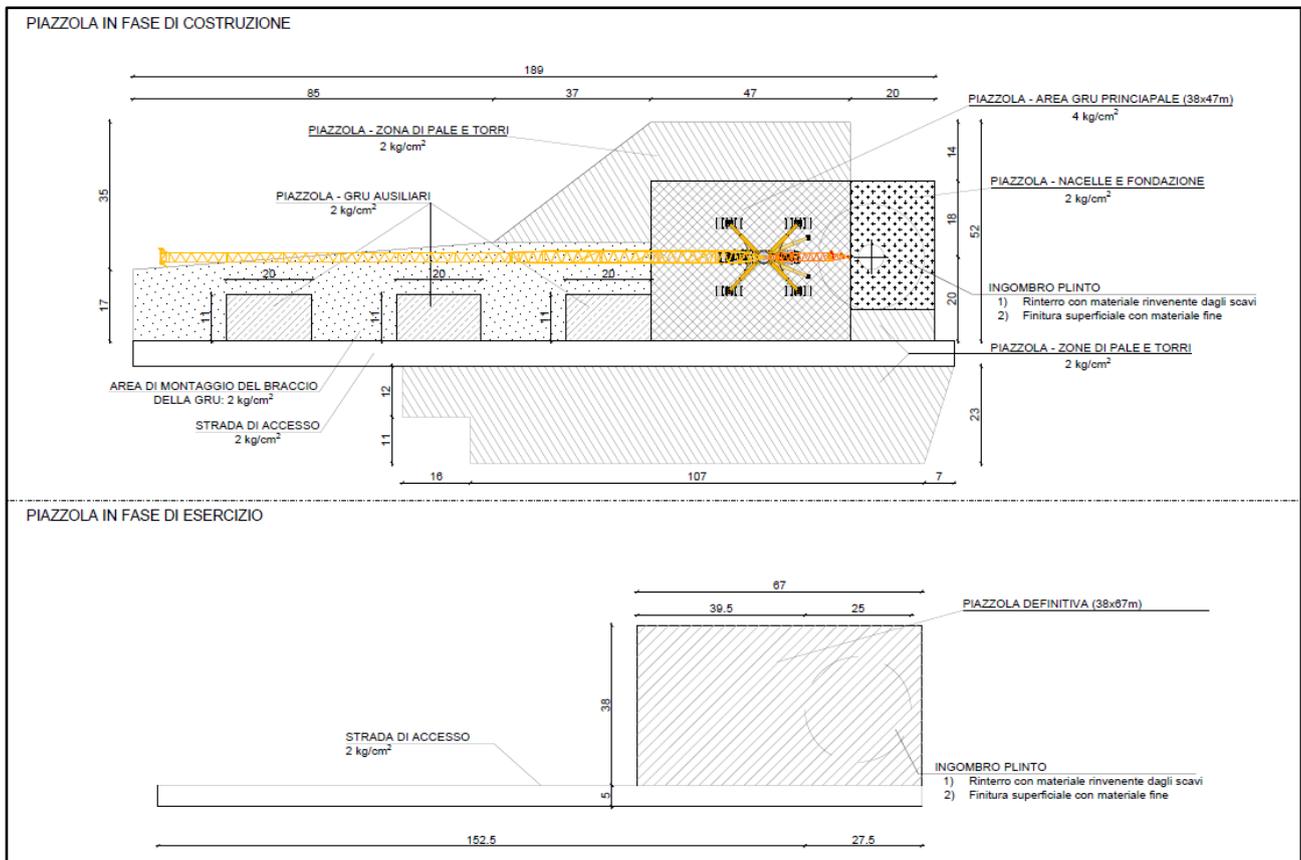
Planimetria piazzola tipo per la fase di installazione e fase di esercizio e manutenzione
